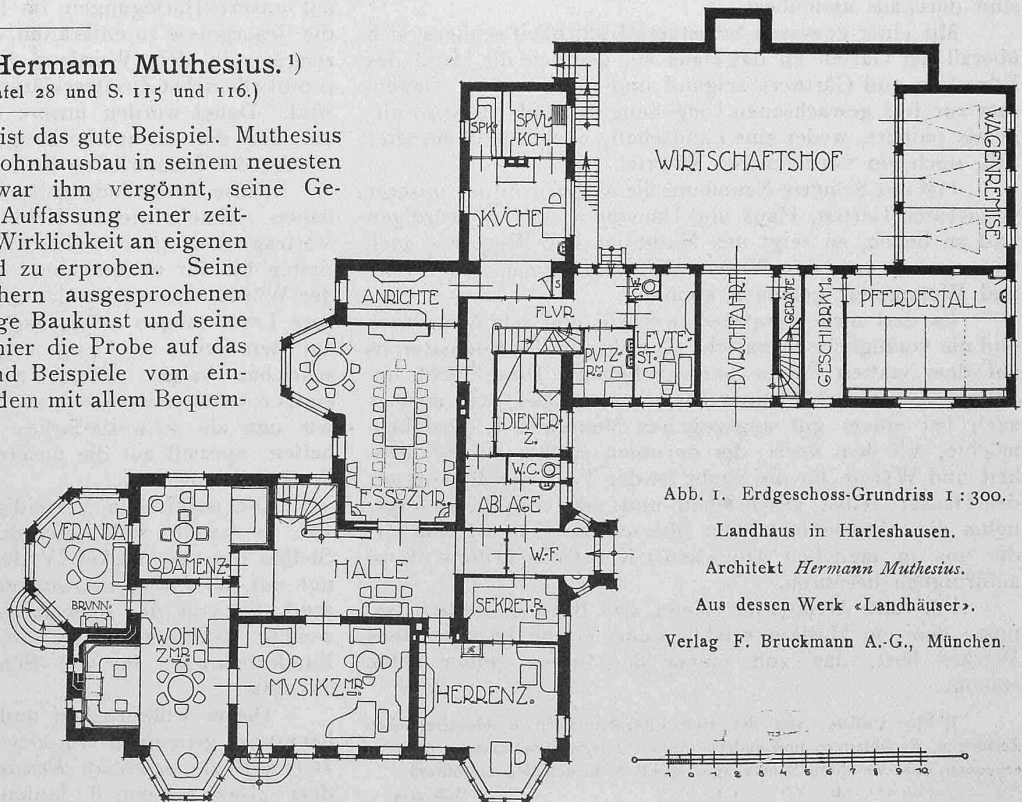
Erdgeschoss-Grundriss 1 : 300.
